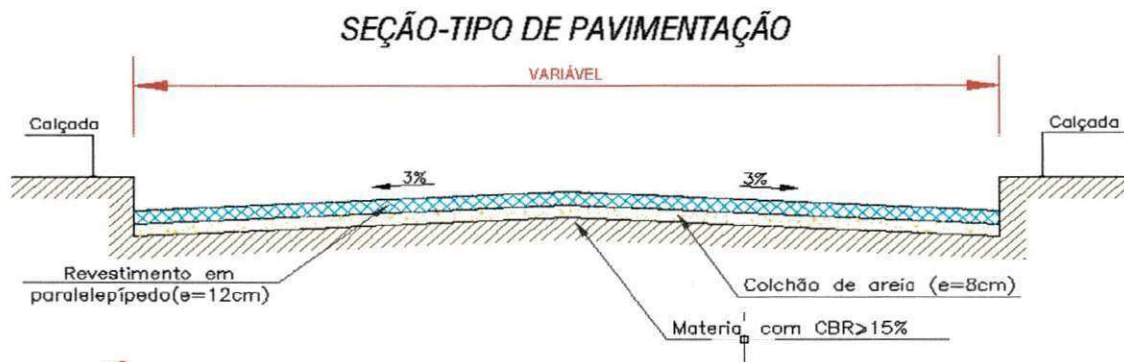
Seção tipo de pavimento das ruas de Paulista
